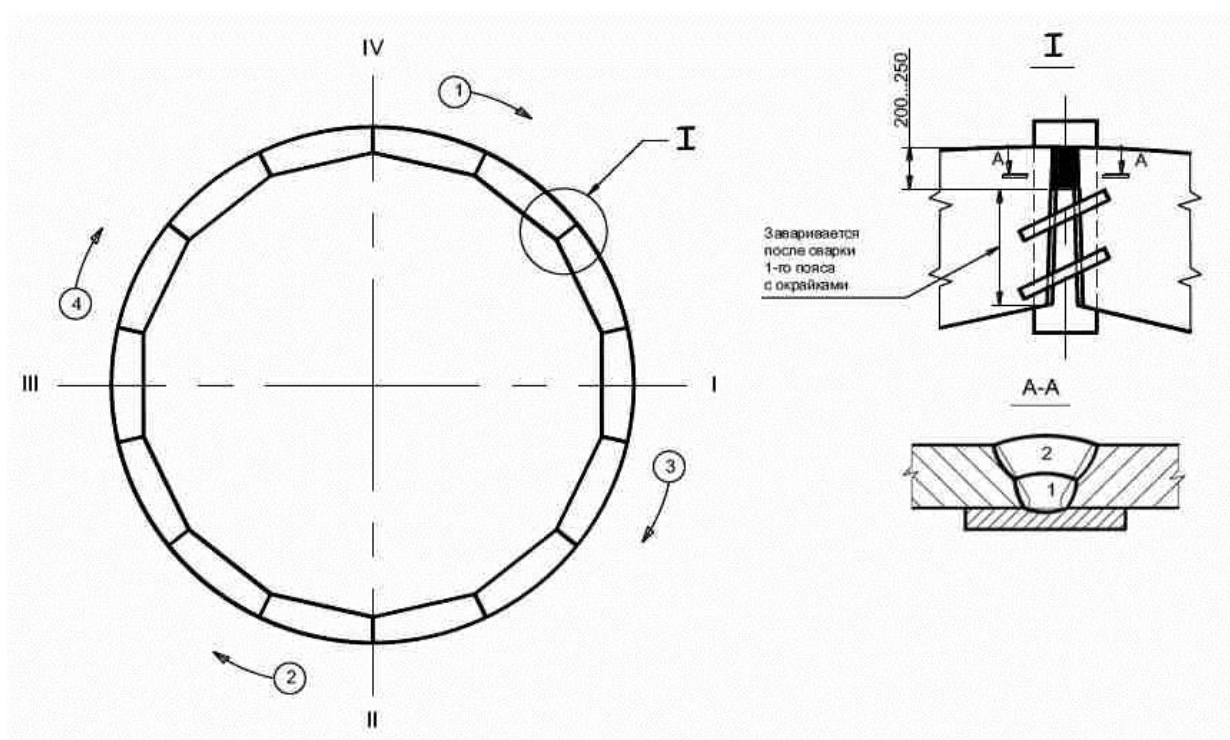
Схема выполнения сварных швов кольца окраек
